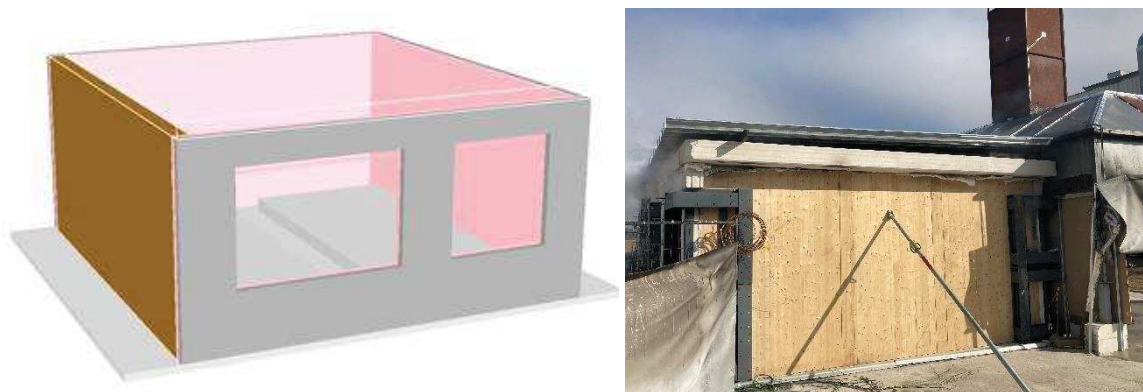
Schéma et prise de vue de la configuration Paroi CLT MUF (Essai 1)
